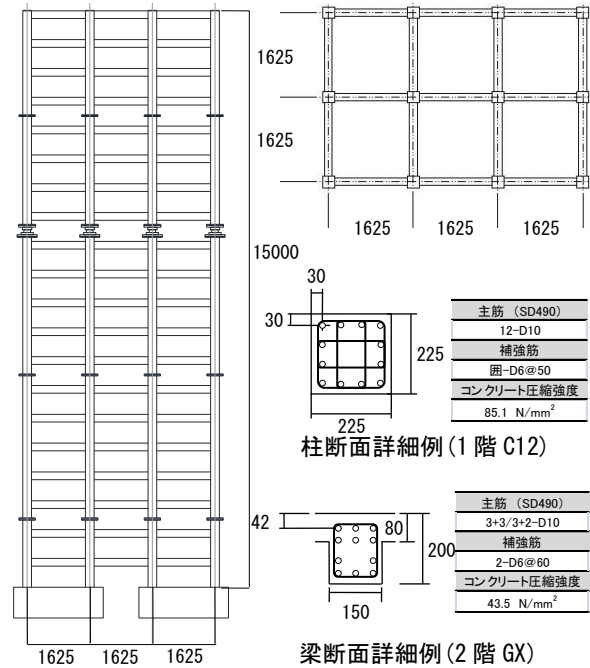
試験体図、柱・梁断面図（単位：mm）¹⁾
